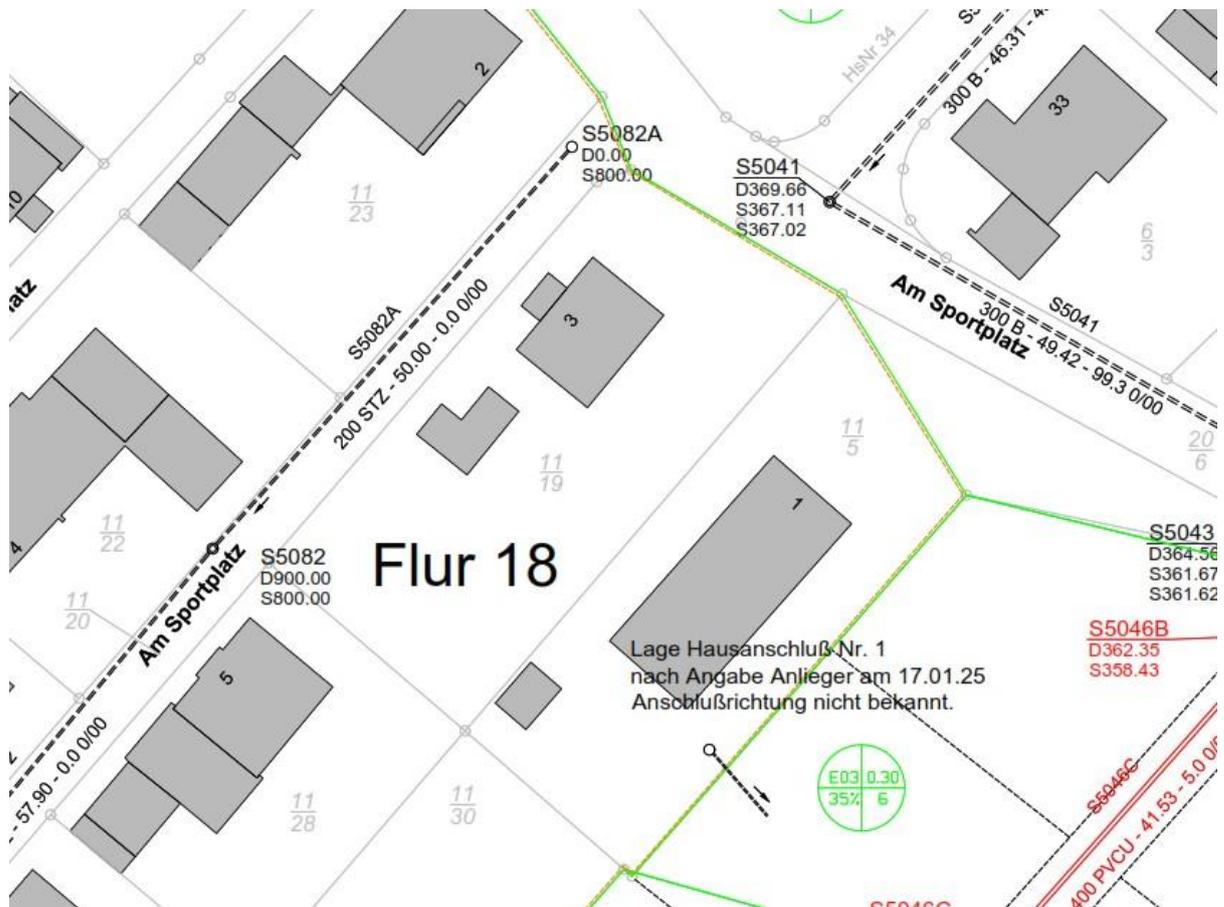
\_Lage Hausanschluss Am Sportplatz Nr. 1
